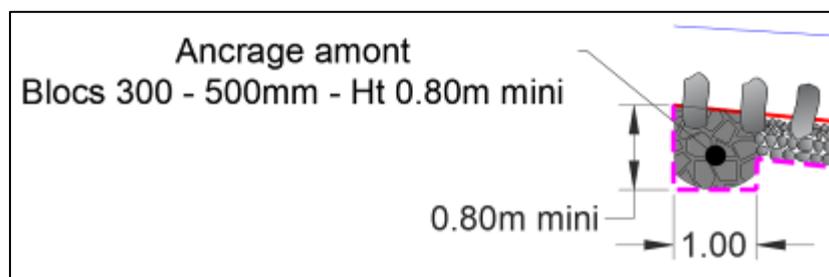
Aménagement type sur ancrage amont (coupe longitudinale) (SOGETI, 2021)
